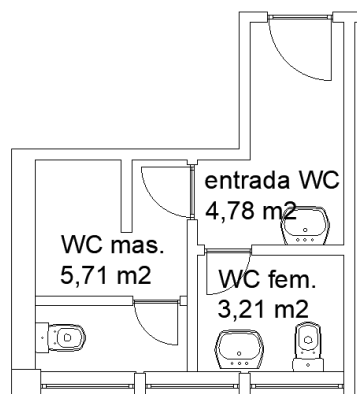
Planta em 2D das casas de banho da AE ISEC.
